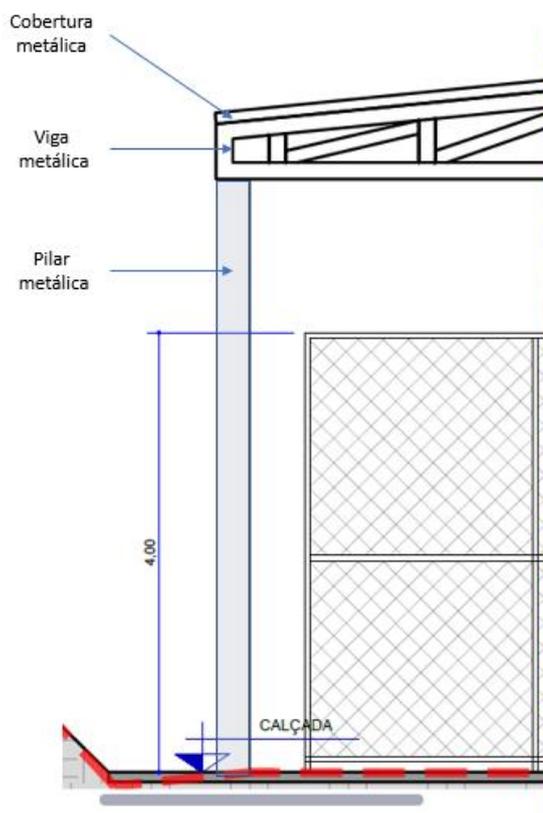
ESTRUTURA DA COBERTURA EXISTENTE
